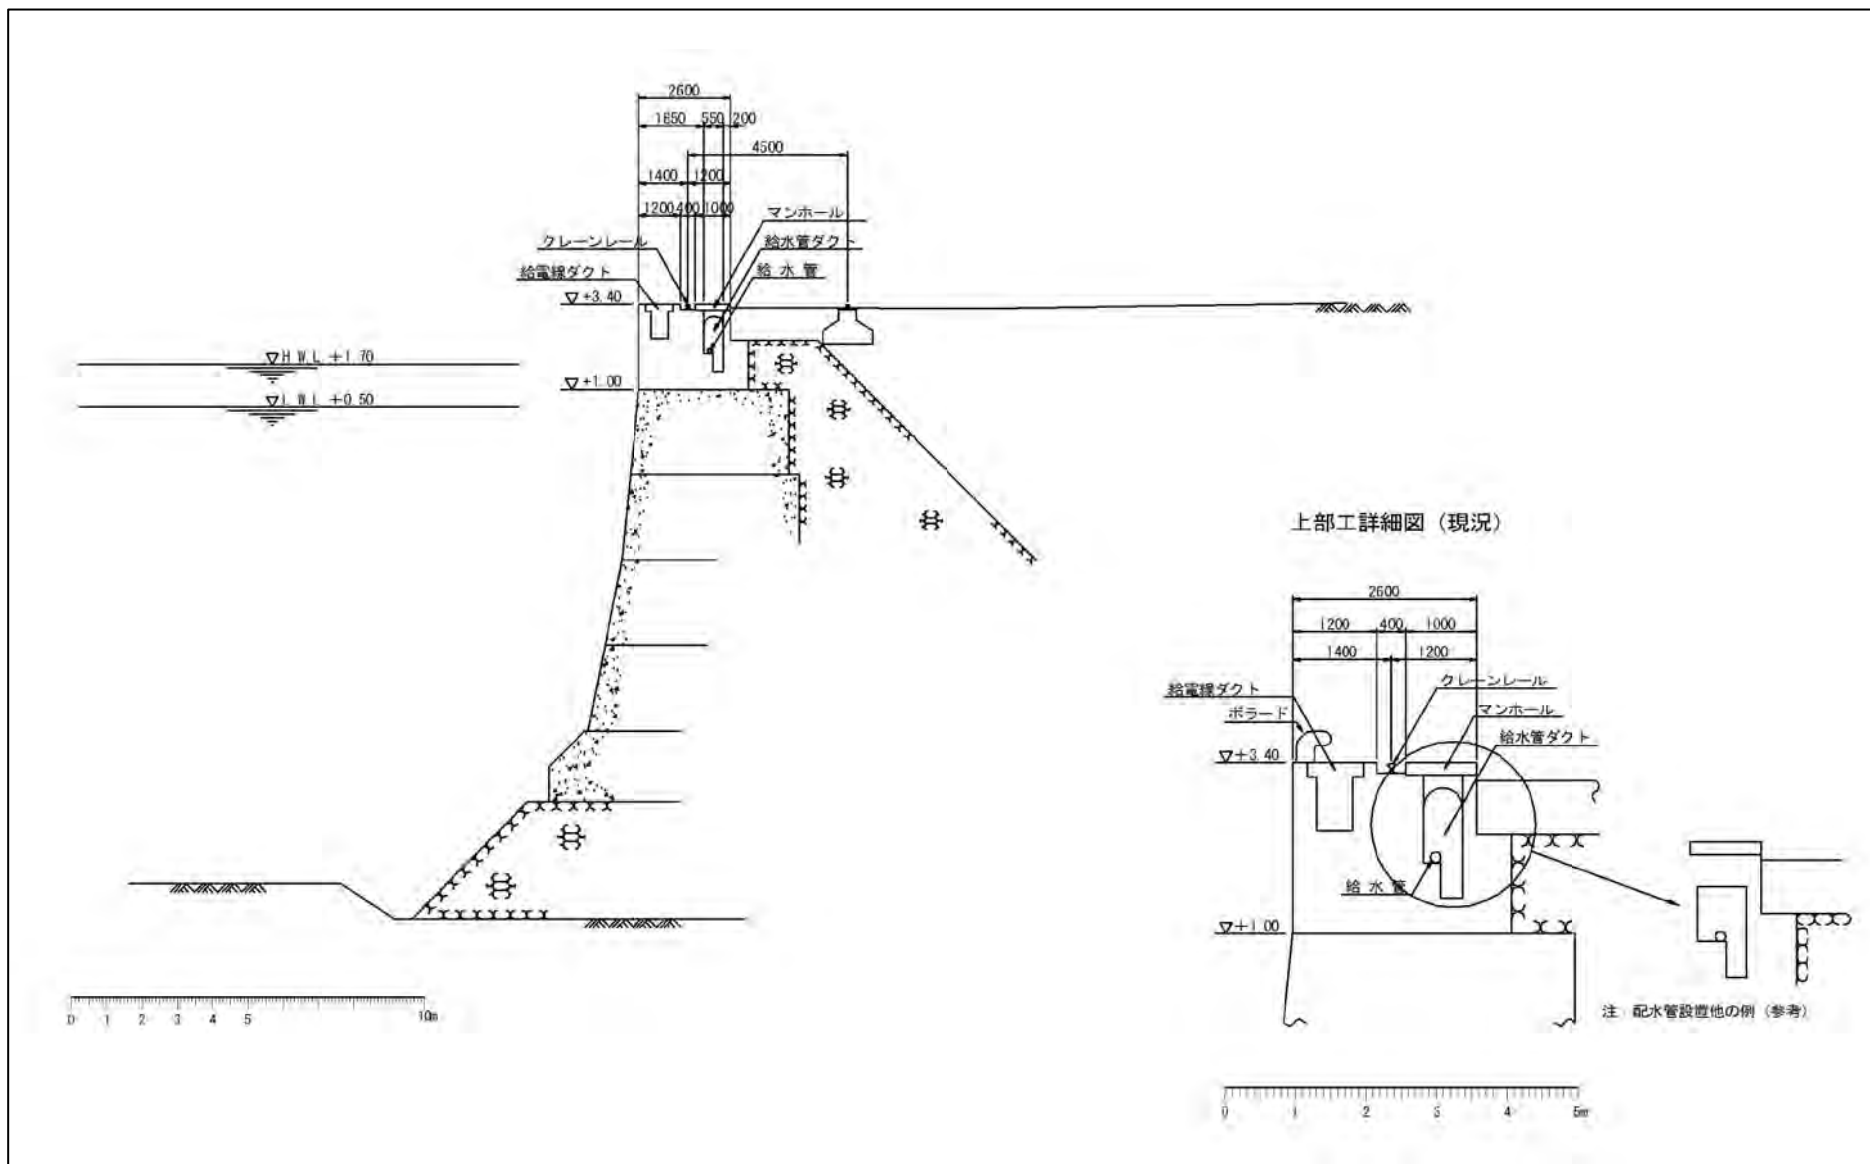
No. 3B 岸壁標準断面図 (現況)
